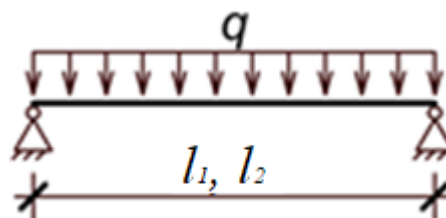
Расчетная схема балок перекрытия
